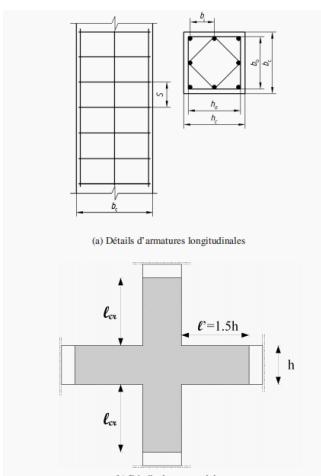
Détails d'armatures longitudinales et Détails de zone nodule
